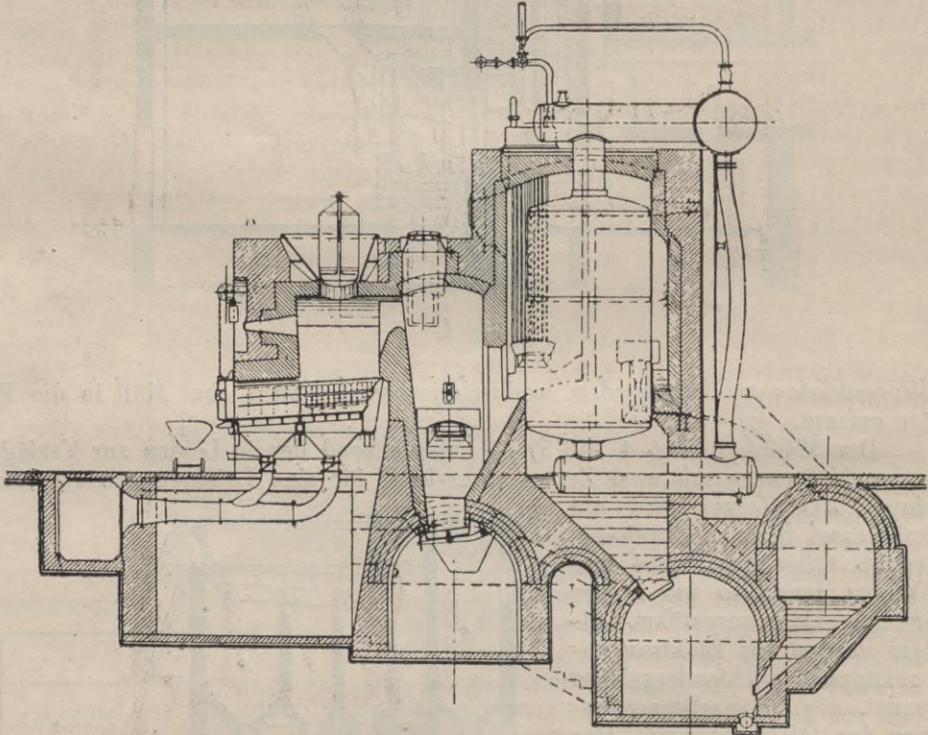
Stehender Rauchröhrenkessel der Müllverbrennungsanstalt der Stadt Barmen.
